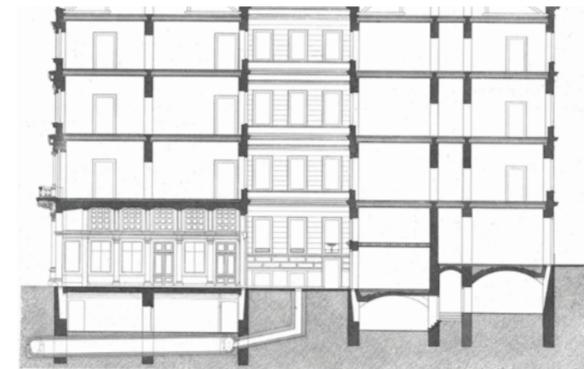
Schwindgasse 5 – publizierte Pläne 1875, Lageplan 1886
